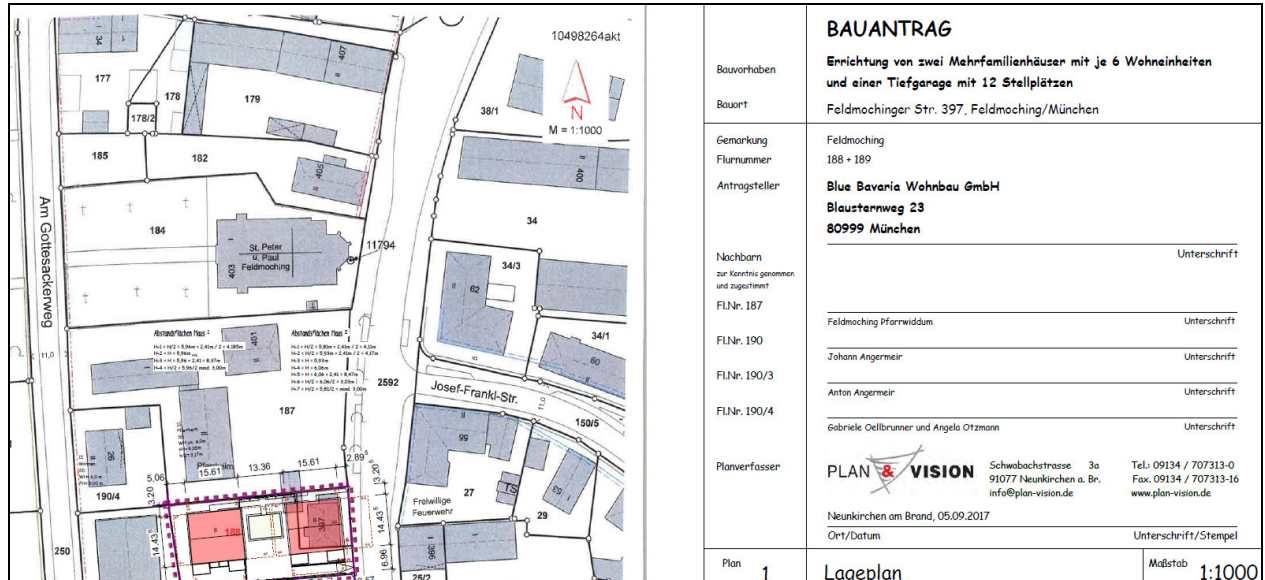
Plan des Bauantrages Feldmochinger Straße 397 (© Plan & Vision, Neunkirchen a. Br.).
